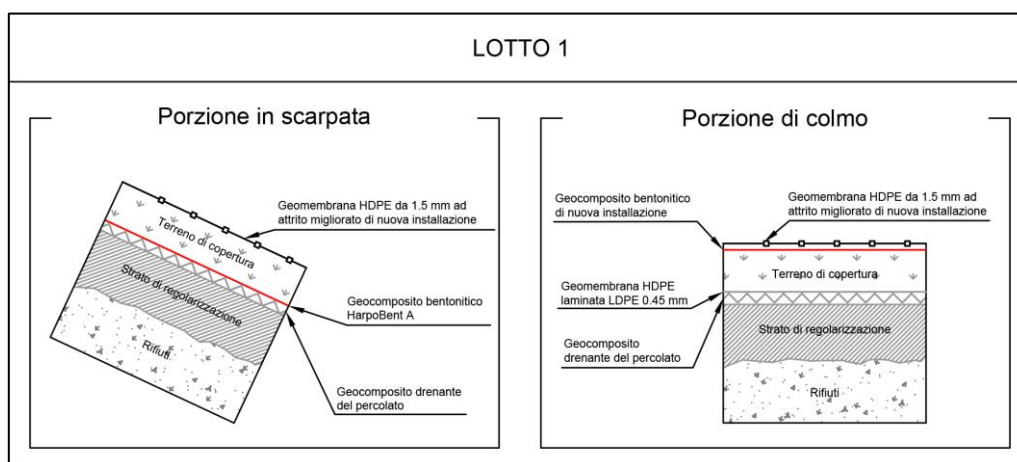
6 – Sezione tipo LOTTO 1, area interna al sedime di LOTTO 5
